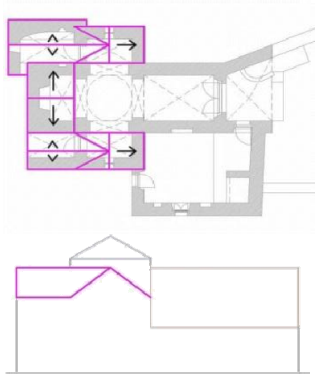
Esquema de cobertura tradicional de igrejas de planta em cruz latina.
